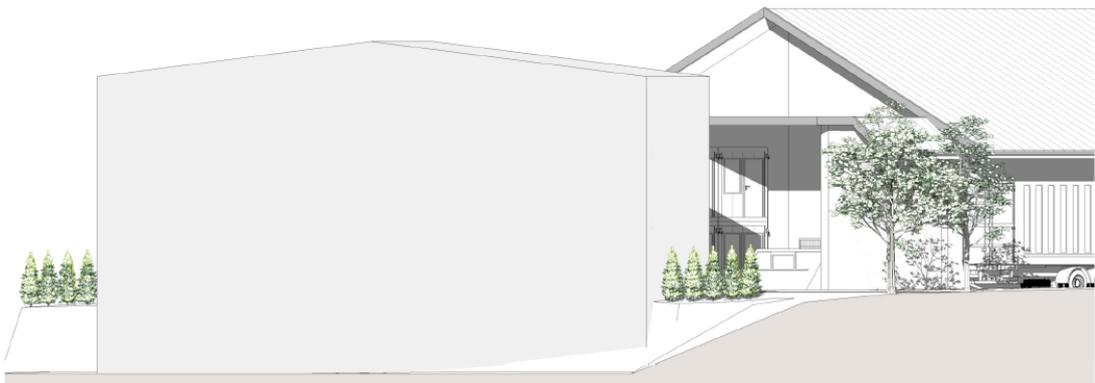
Ansicht West seitens des Planungsbüros m³ PLAN + BAU GmbH (ohne Maßstab)
